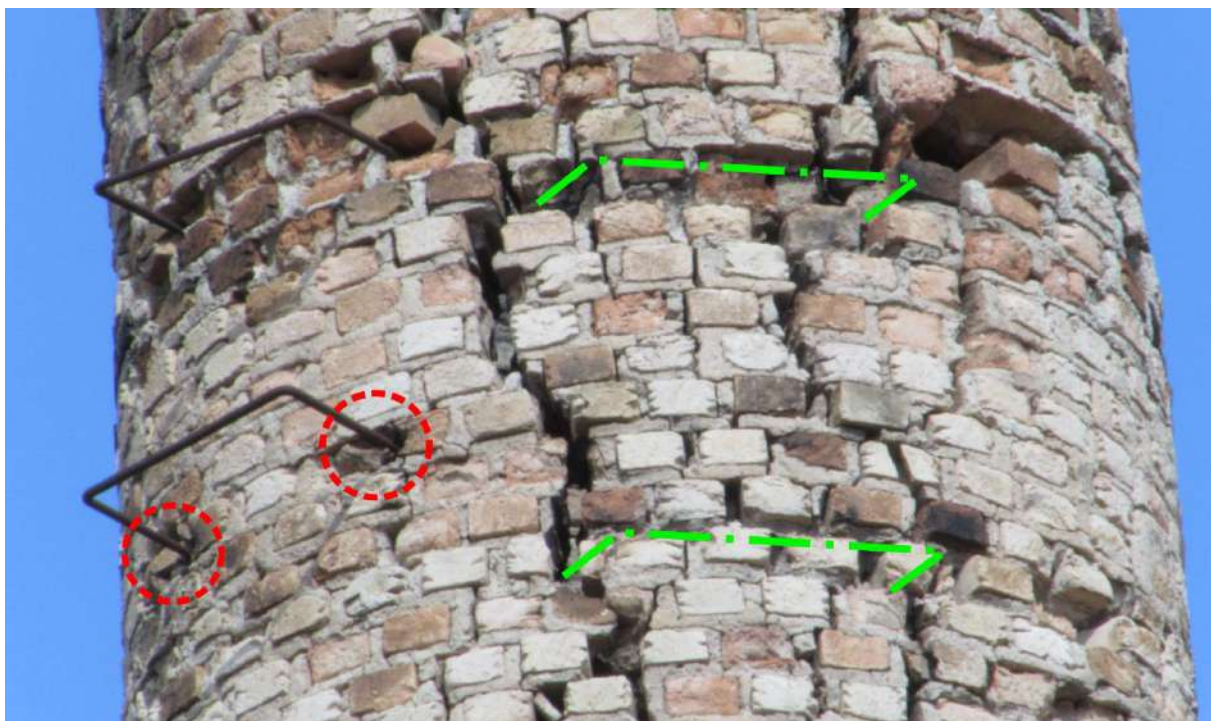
Detalhe da fixação da escada externa (circulado em vermelho) e croquis da posição estimada dos degraus internos originais (em verde) - Elevação OESTE / Região D
